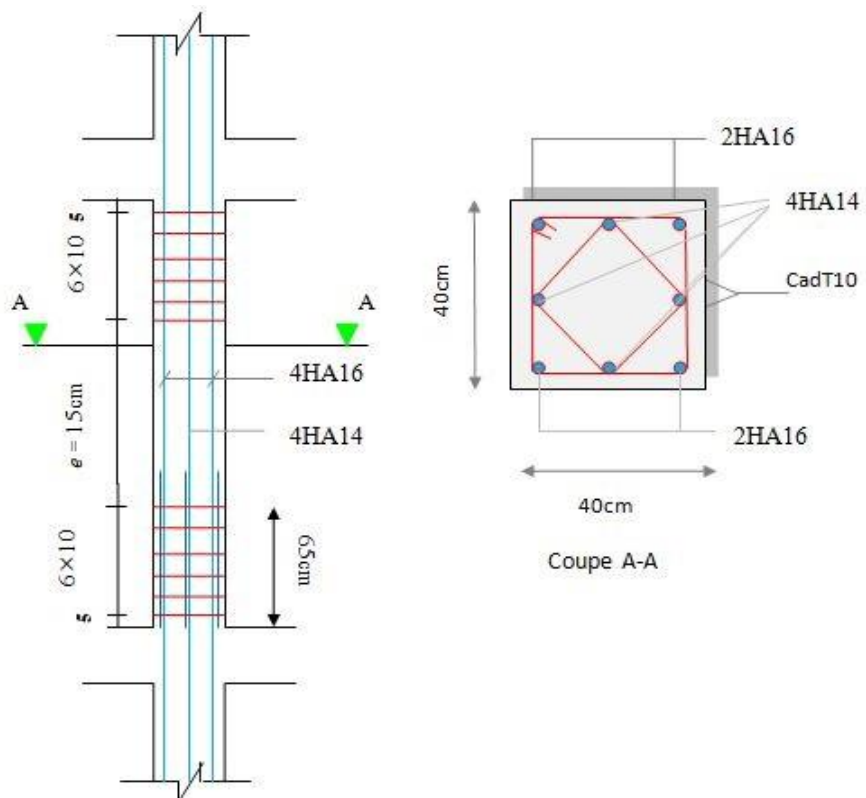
Schéma de ferrailage des poteaux40 x 40
